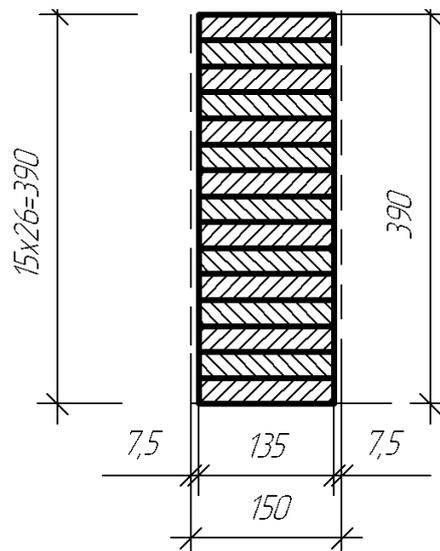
Компоновка поперечного сечения верхнего пояса фермы.
